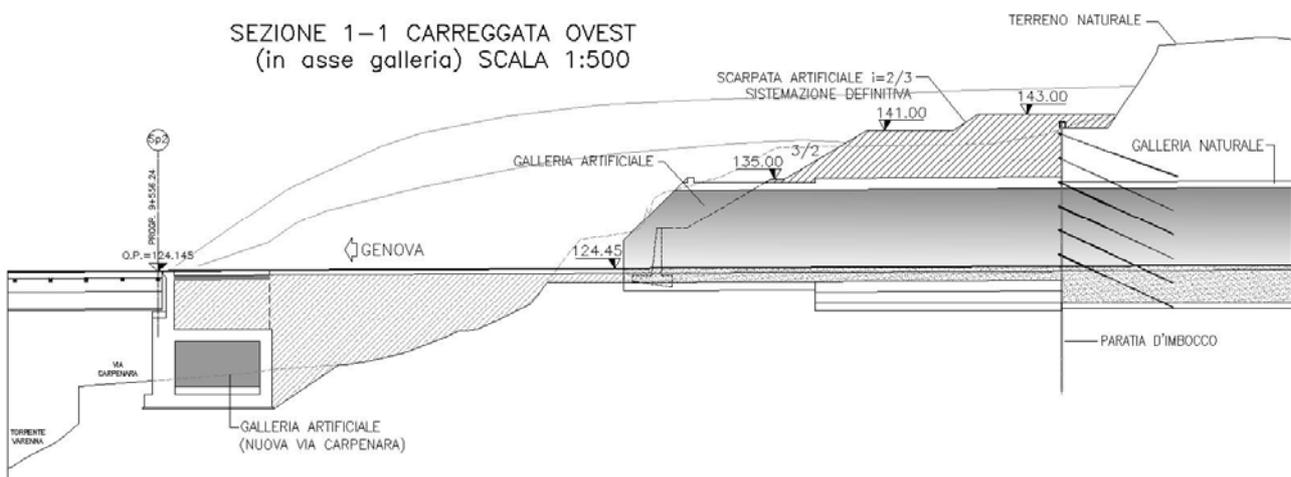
Sezione longitudinale in asse galleria (cfr. AUA0146-1)
